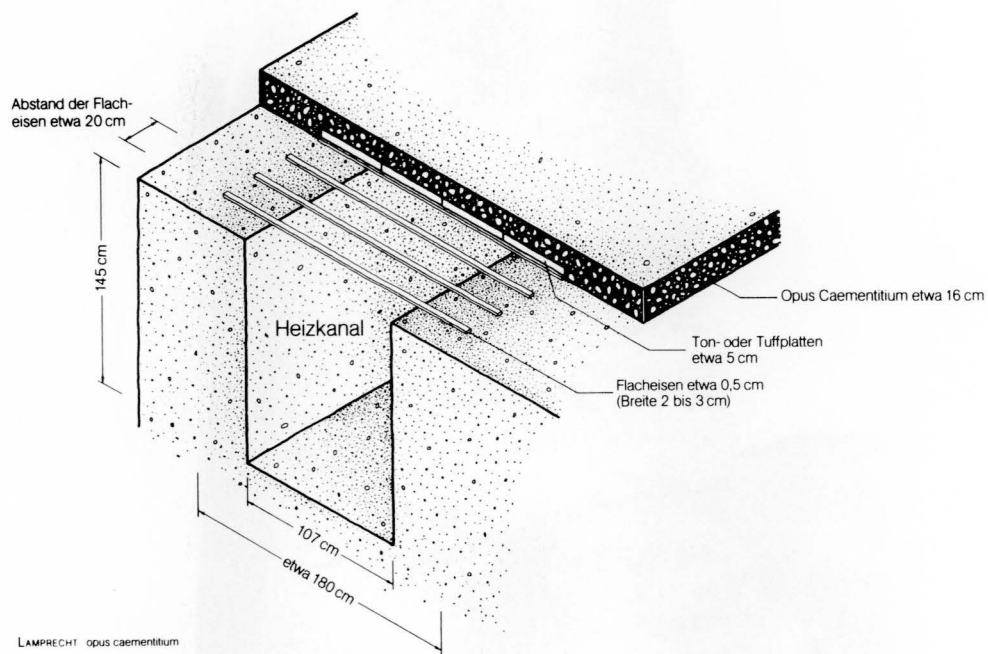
Römischer Beton mit Eisenverstärkung. Die Decke eines Heizkanals bei Klagenfurt/Österreich bestand aus einer Betonkonstruktion, bei der die Zugkräfte durch Flacheisen aufgenommen wurden.
